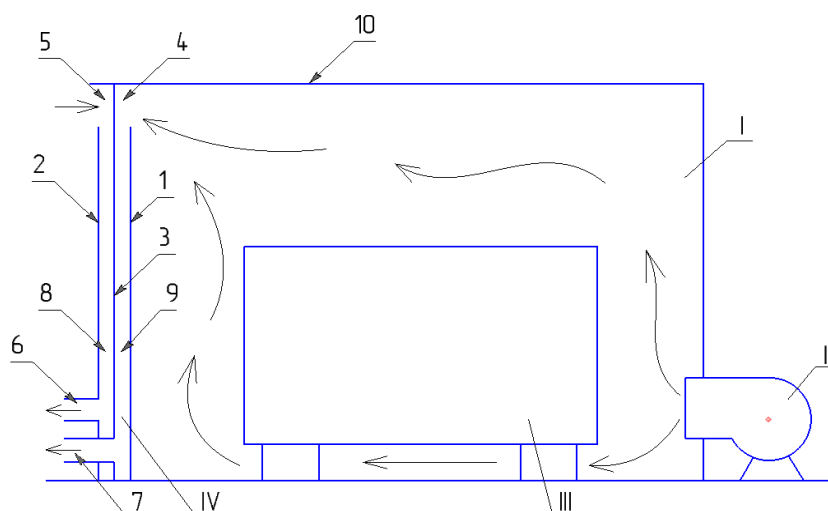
Система воздушного отопления в энергосберегающем шатровом укрытии:
